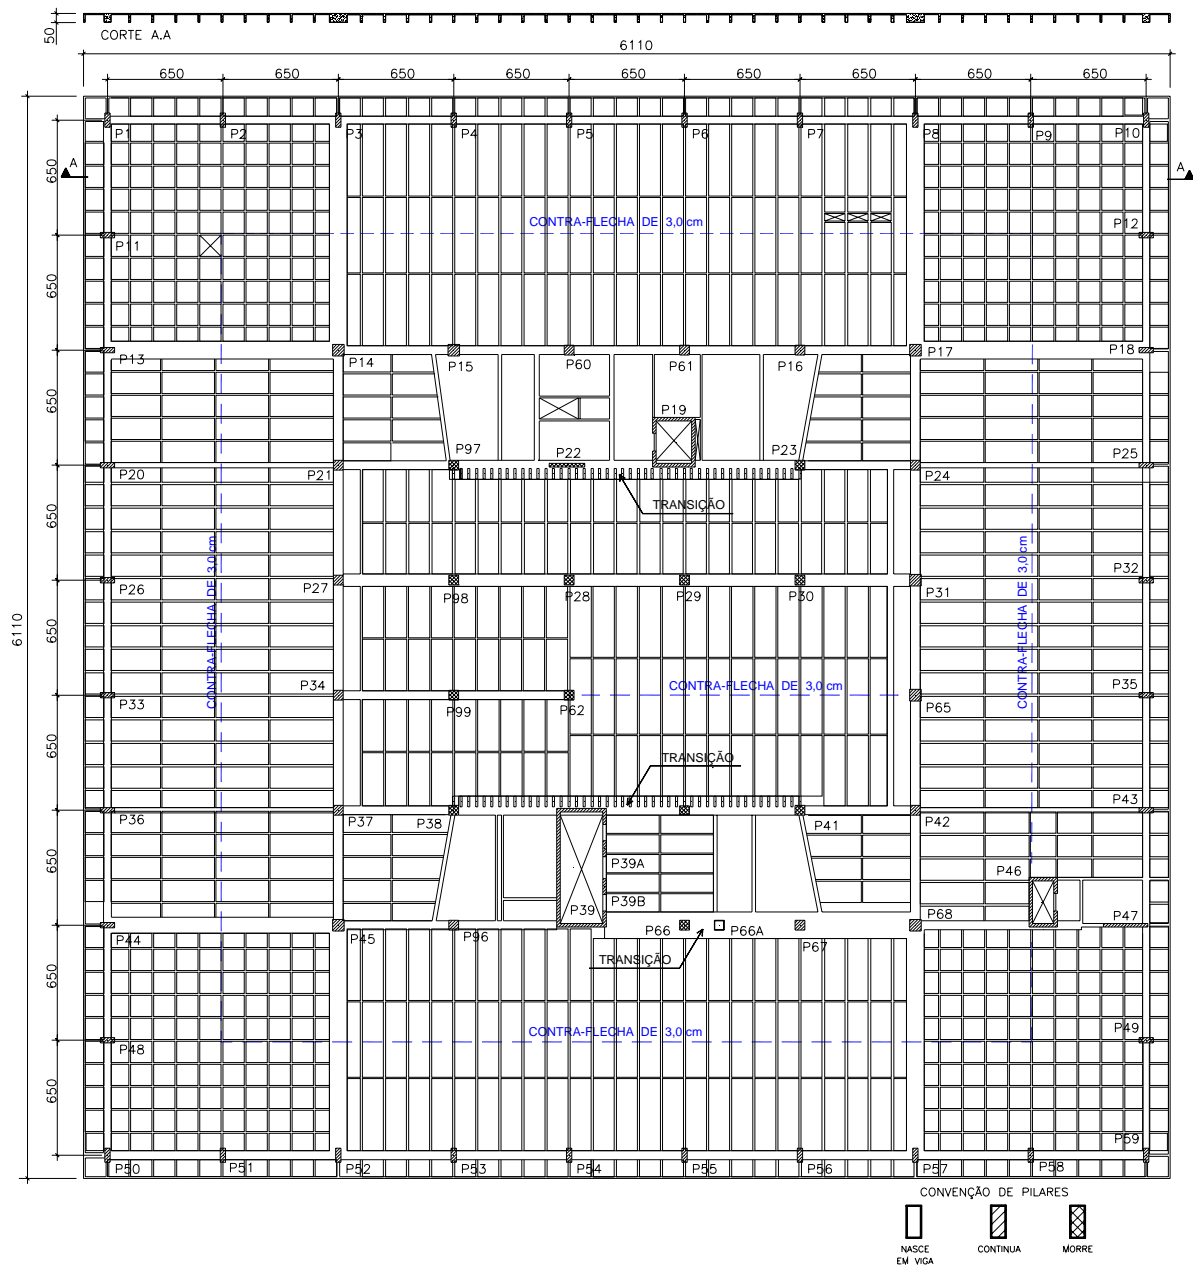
Fôrma do 3º. pavimento do Palácio da Justiça (sem escala)
